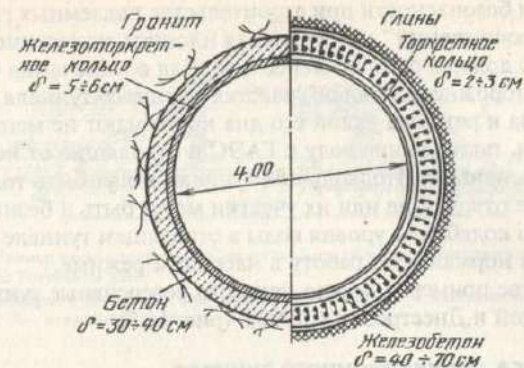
Поперечное сечение гидротехнических туннелей (напорный туннель №2 Храмовской ГЭС)
